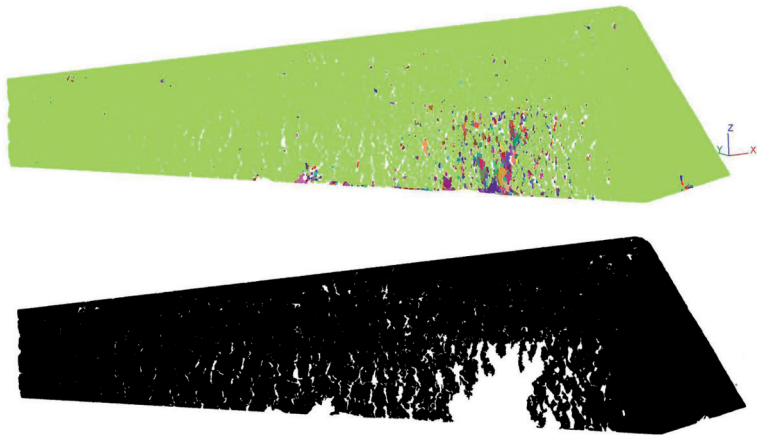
Filtro a 0,5cm. de separación entre puntos, aplicado al muro de la fachada sur (Caso1).
